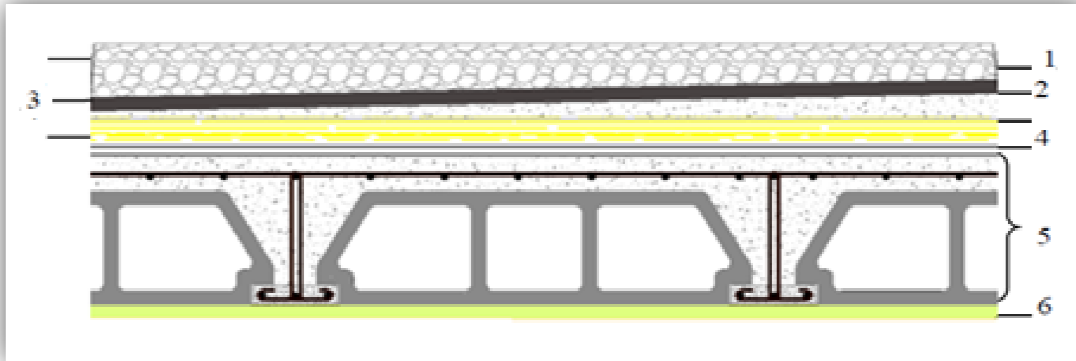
Composants d'un plancher terrasse en corps creux.
